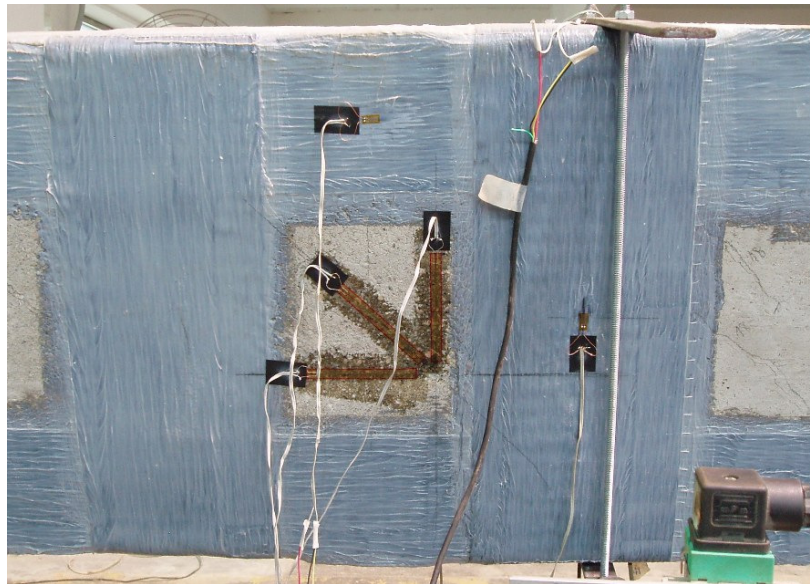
Detalhe dos EER colados no concreto e no CFC.
